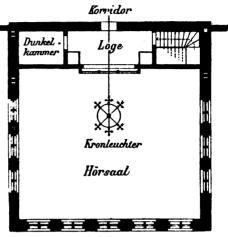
Oberer Grundriss (Schnitt a-b).
